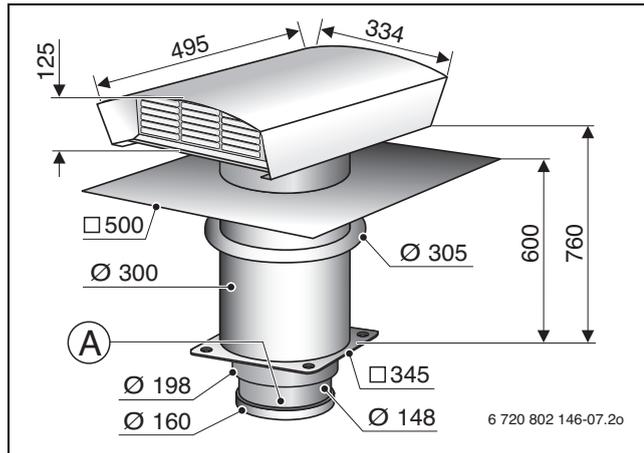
Dimensioni per bocchetta a tetto DDF 160/1 (quote in mm)
